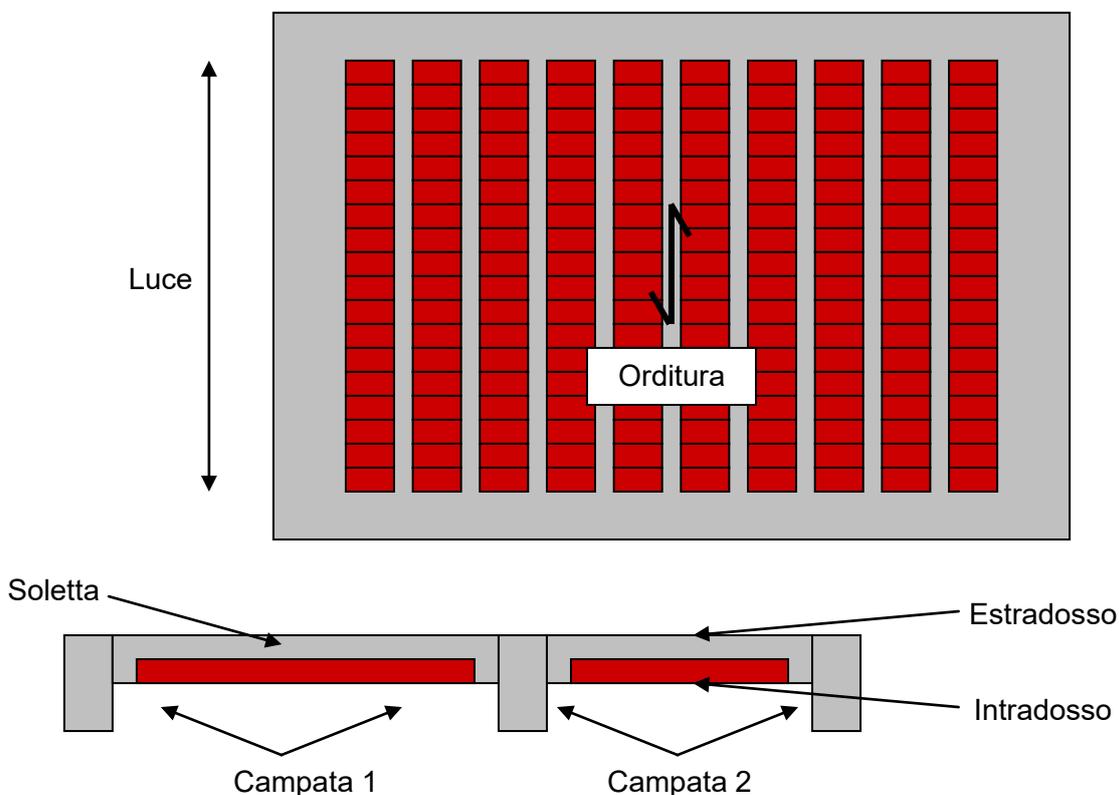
Carpenteria e sezione solaio in c.a.
